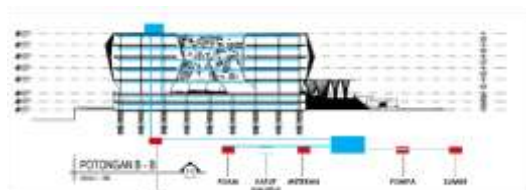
Sistem Kulit Bangunan (penulis, 2023)
